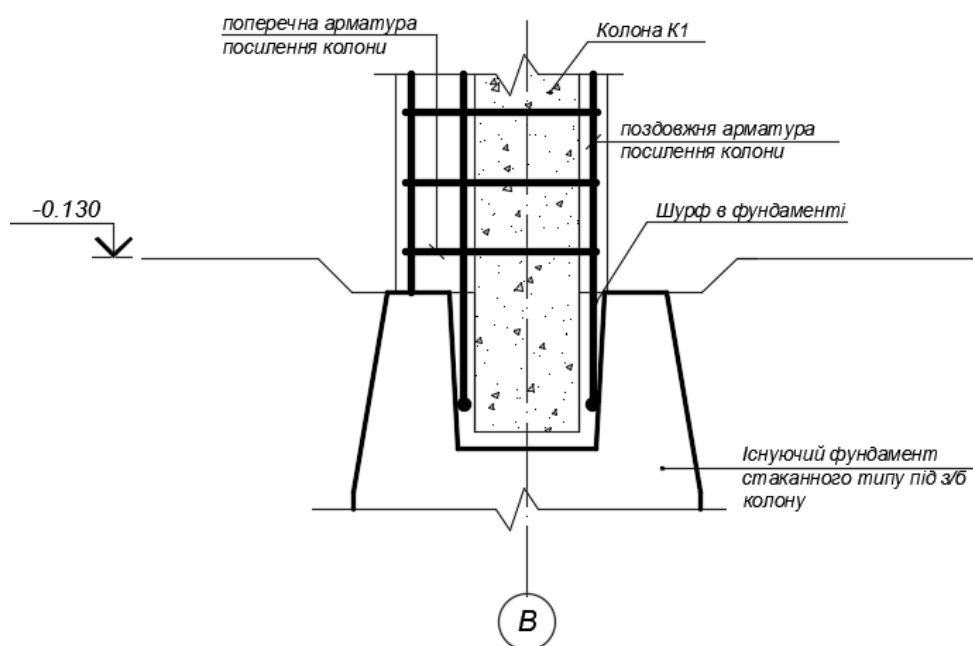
Вузол підсилення залізобетонної колони на ділянках сполучення з фундаментом
